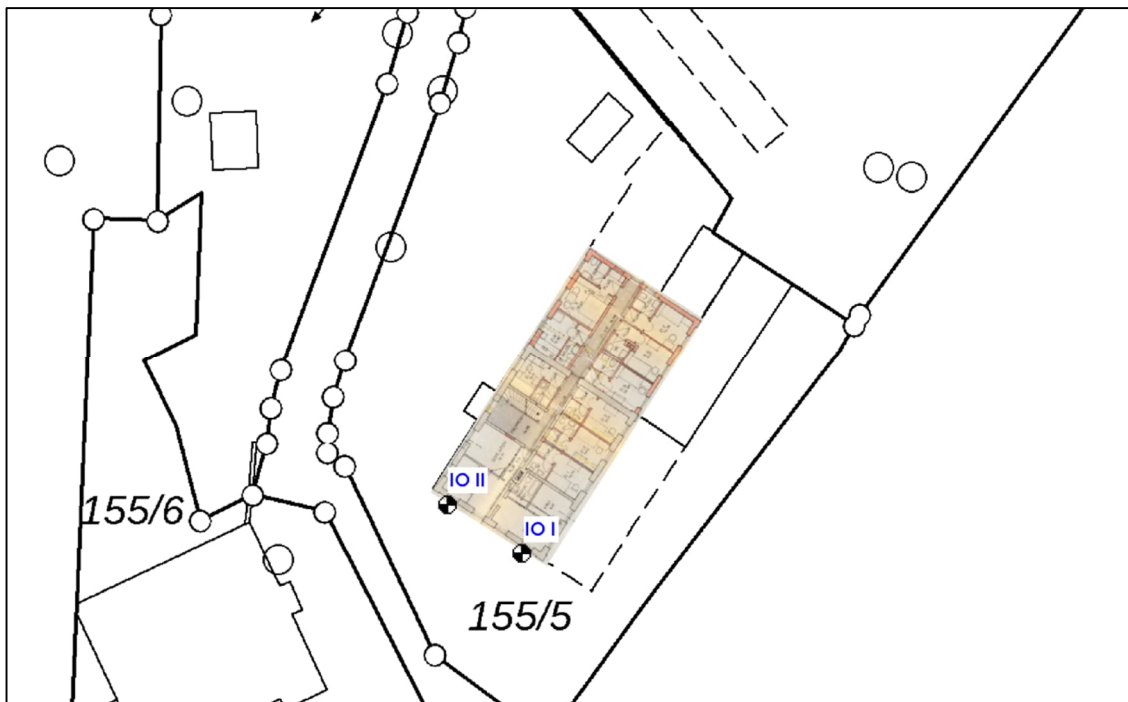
Lageplan /19, 28/ mit Darstellung der bestehenden maßgeblichen Immissionsorte auf dem Planungsgrundstück
